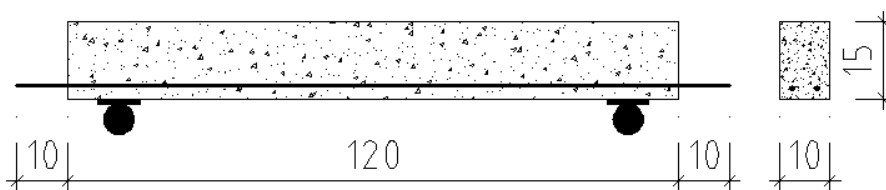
Caracteristicile geometrice ale grinzii din beton armat analizate / The geometrical characteristics of the analysed reinforced concrete (RC) beam.
